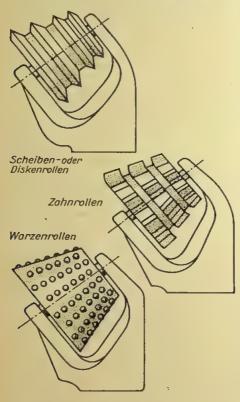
Rollenbohrwerkzeuge für Vortriebsmaschinen
